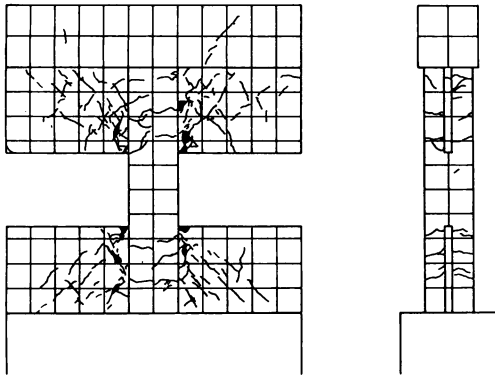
(b) 試験体 CSS02 の最大耐力時のひび割れ図
